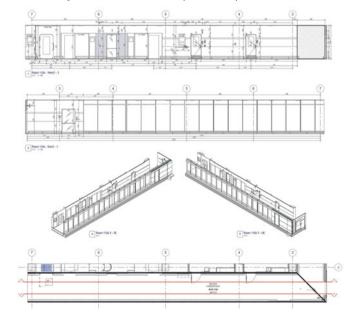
Zoom sur une élévation de mur d'une salle - Extrait de la maquette architecture du projet (© Jacobs).
